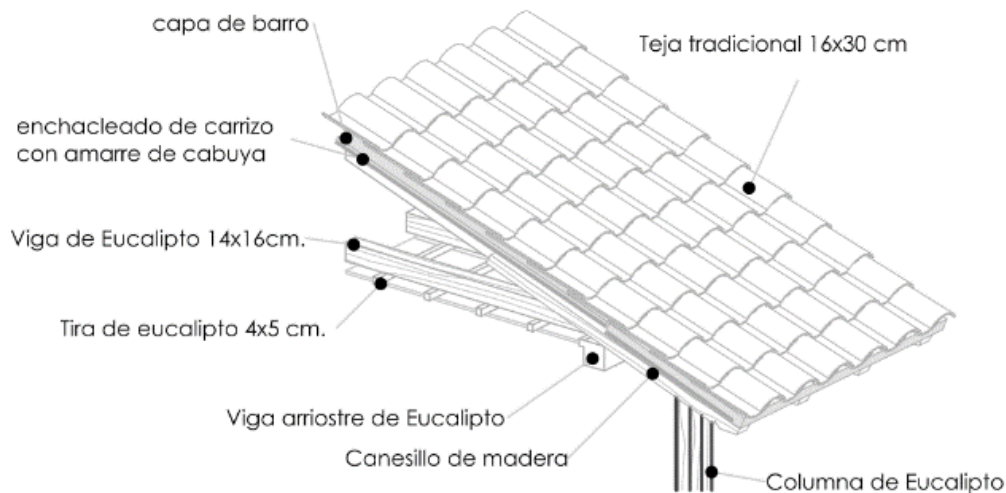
Detalle de cubierta (Caldas & Sigcha, 2017)
